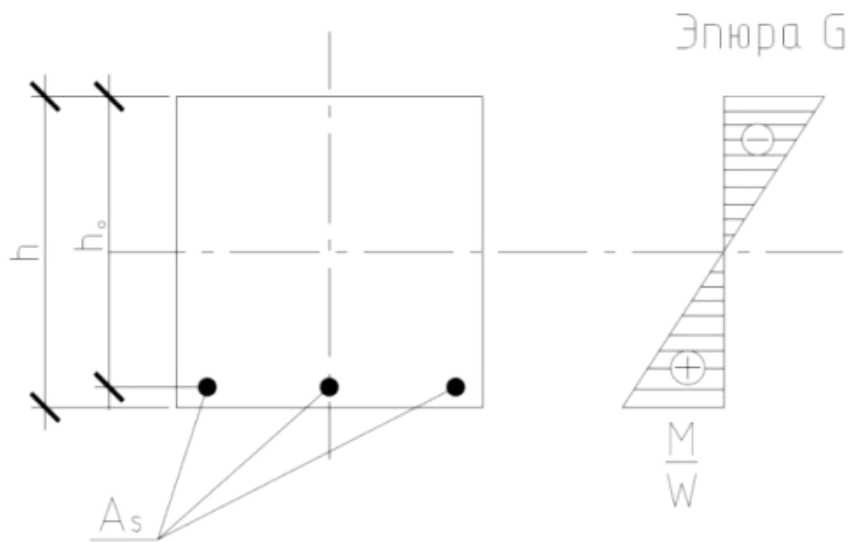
Сечение железобетонной балки с трещинами
